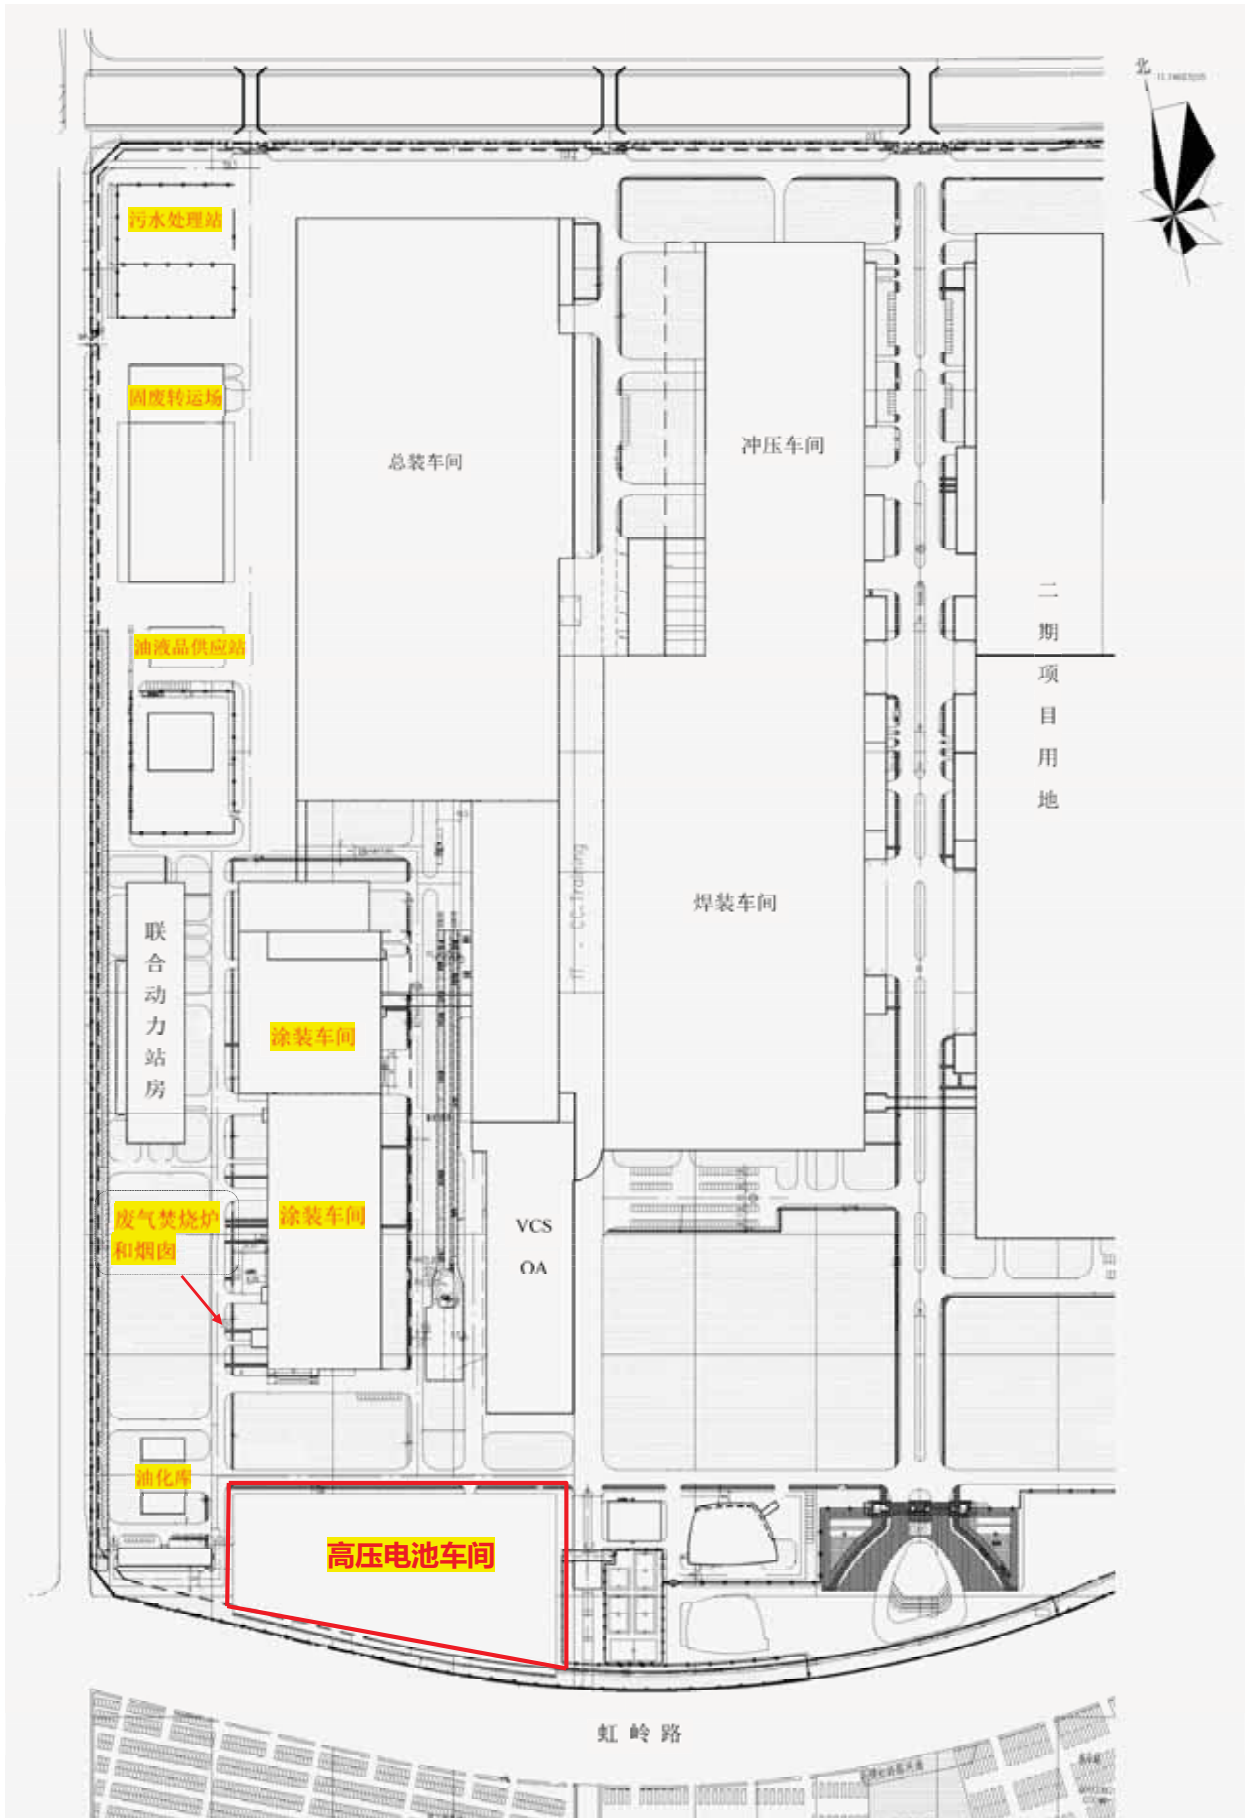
项目平面布置示意图 (在佛山工厂一期厂区位置)
